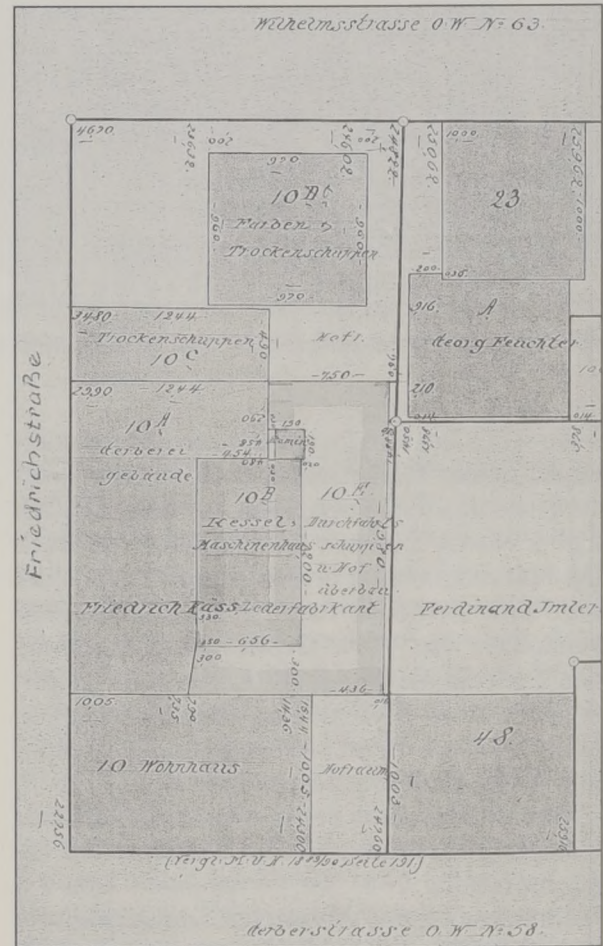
Lageplan vom Grundstück Friedrichstraße 10 mit den vor der Umstellung auf Dampfbetrieb – 1895 – neu erstellten Gebäuden.
